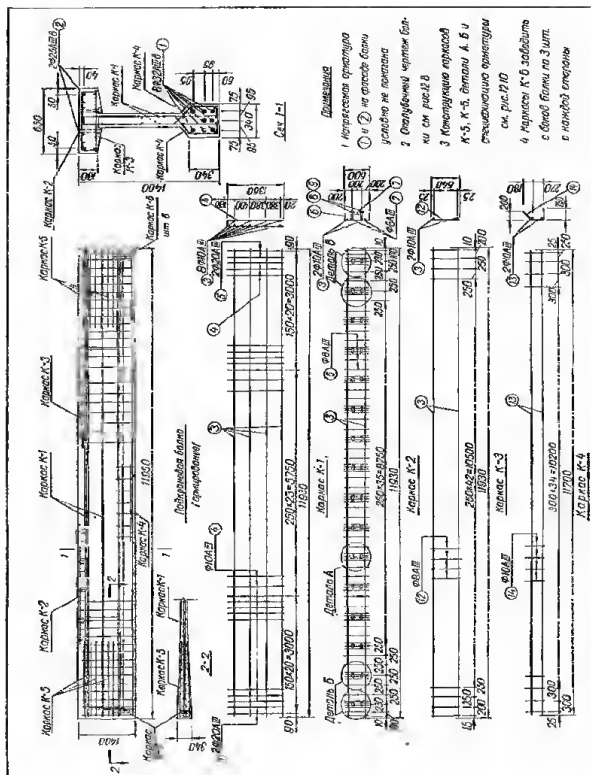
Конструкция сборной подкрановой балки. Армирование и конструкция сварных арматурных каркасов.
